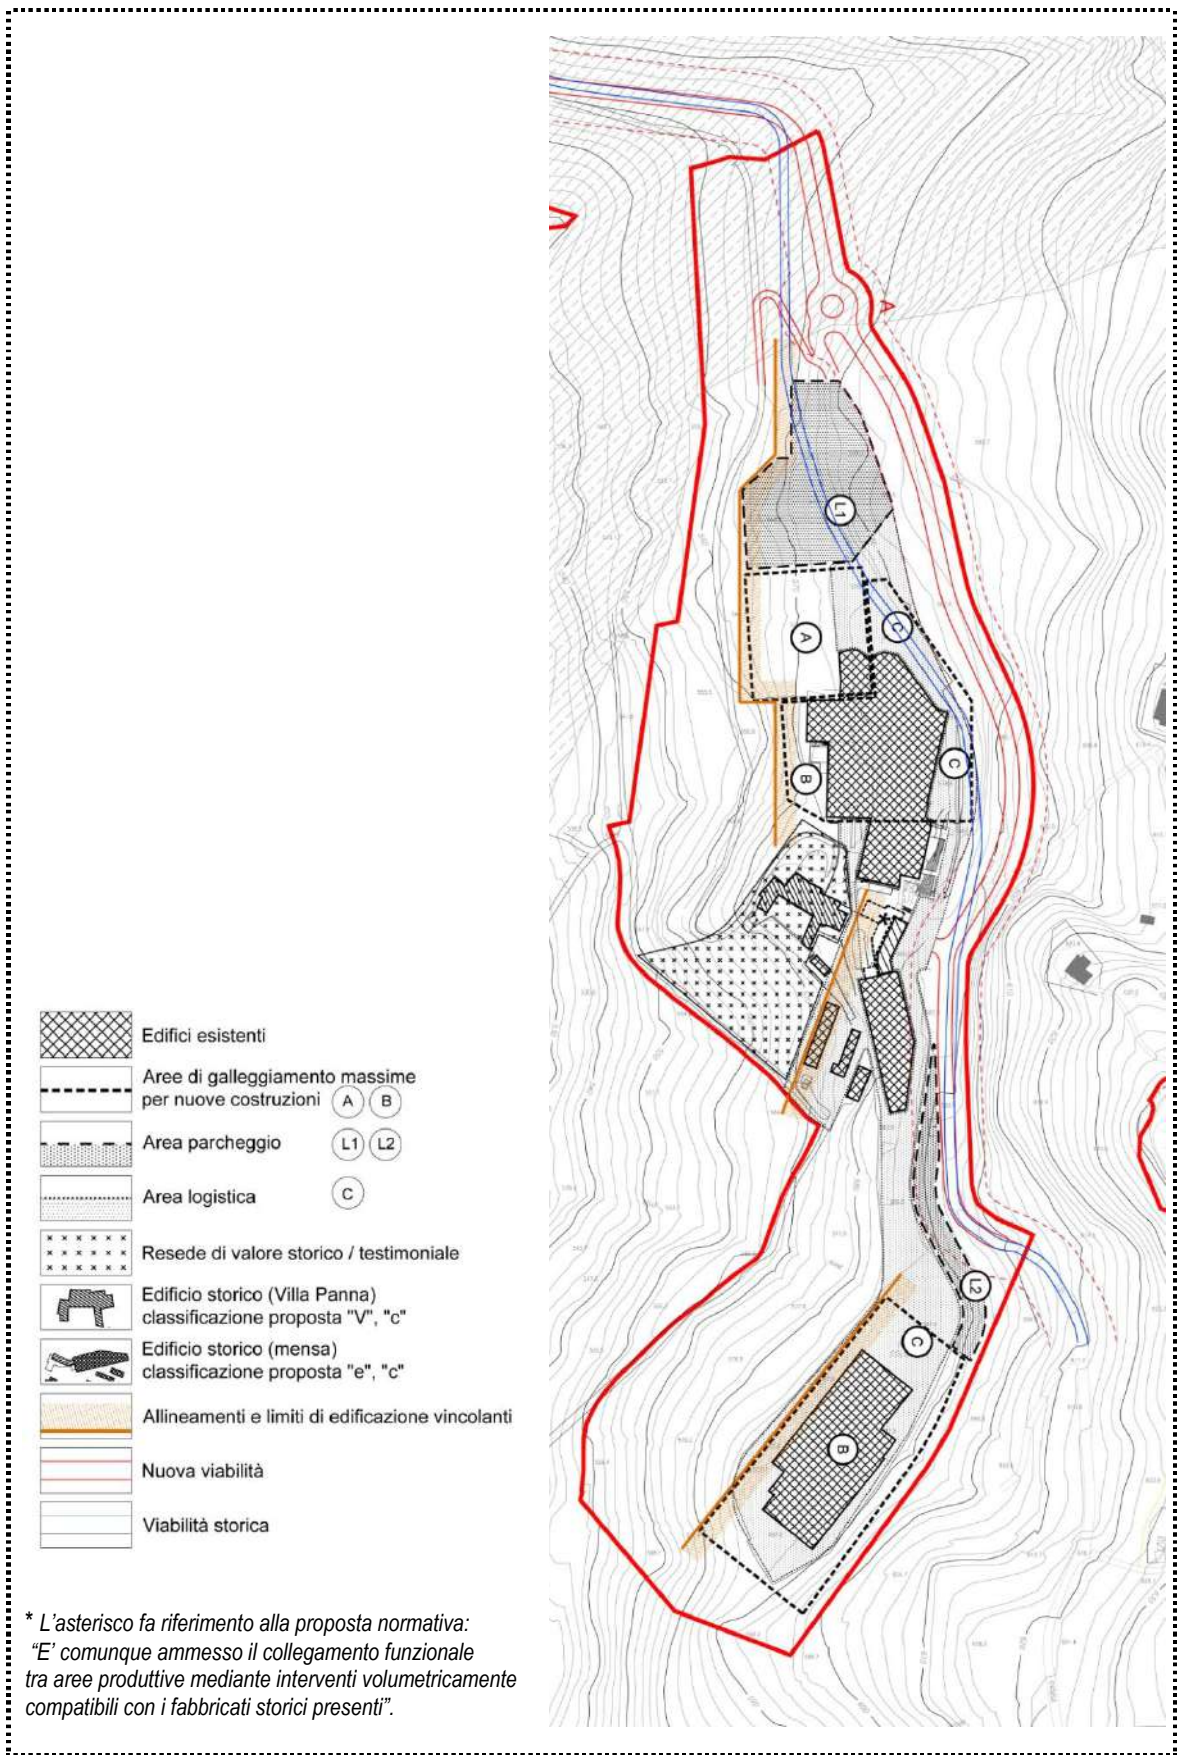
Schema planimetrico Alternativa B "compatta" (2019)
